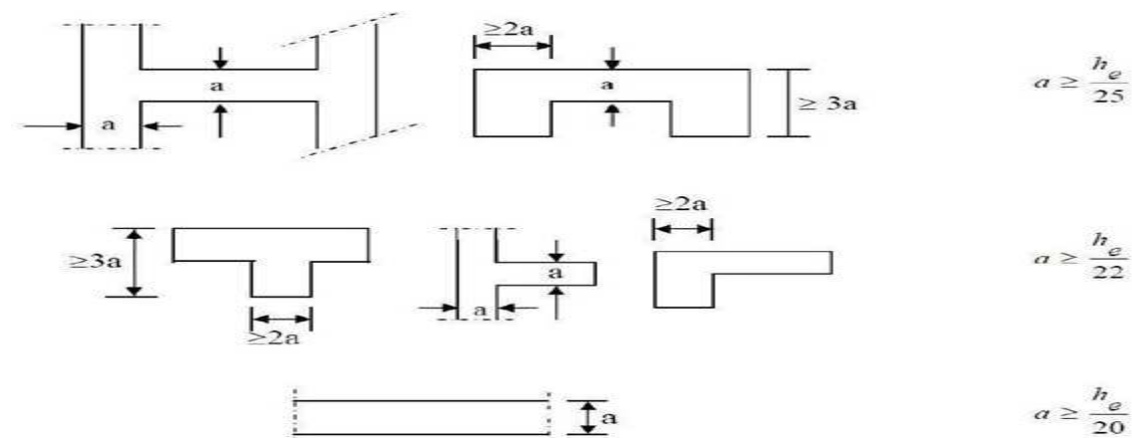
Coupe du voile en plan selon les conditions de rigidité à l'extrémité.
